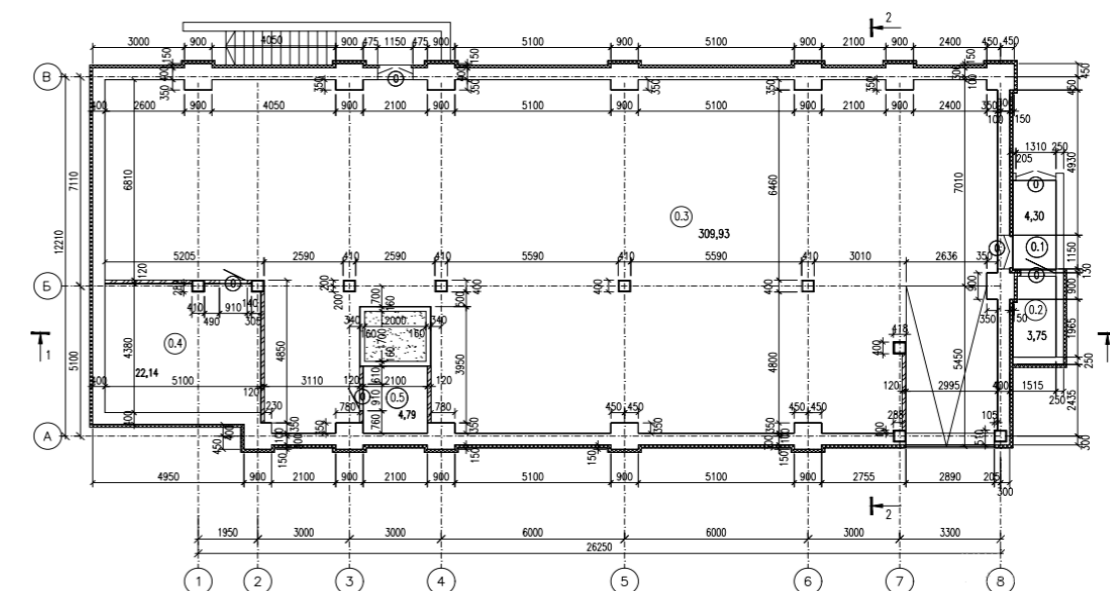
План цокольного этажа здания каркасной конструктивной системы
